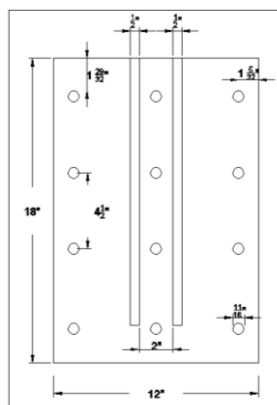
Plancha metálica sobre la cual irán los pernos de anclaje (vista en planta).
